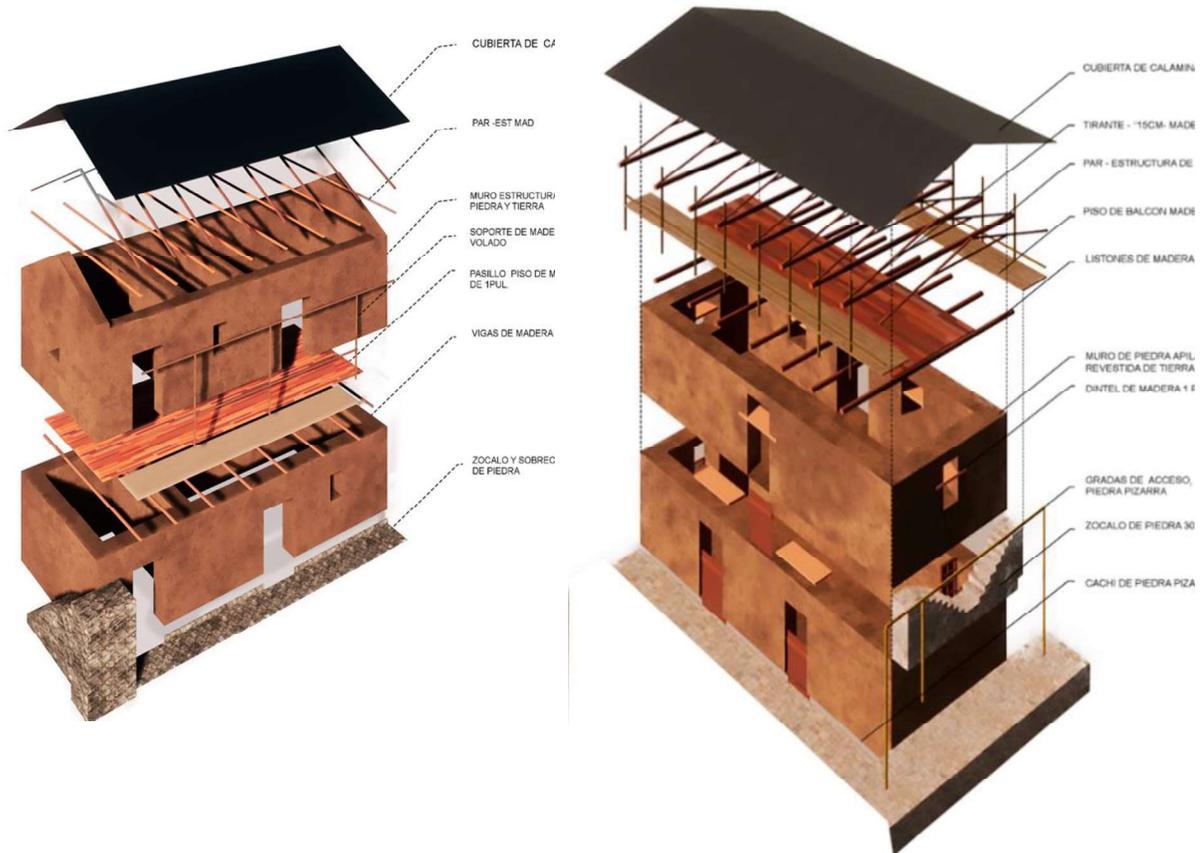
Vivienda tradicional en el pueblo de Zongo
